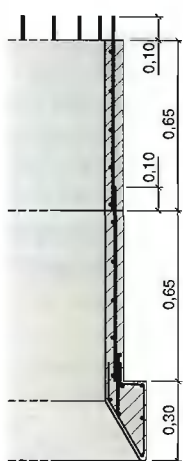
Схема армирования стенок колодца и железобетонного «ножа»
